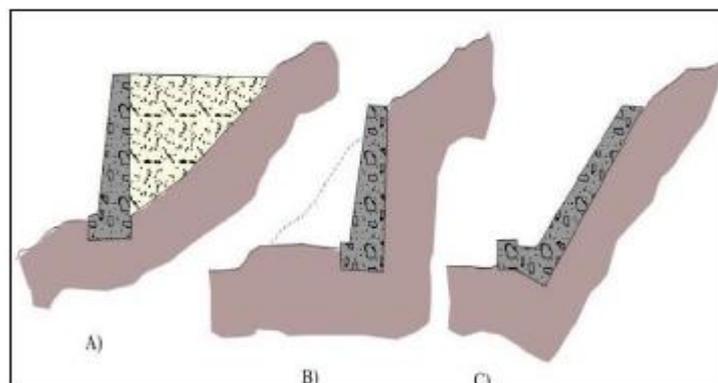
a) Muro de sostenimiento b) Muro de contención c) Muro de revestimiento.
